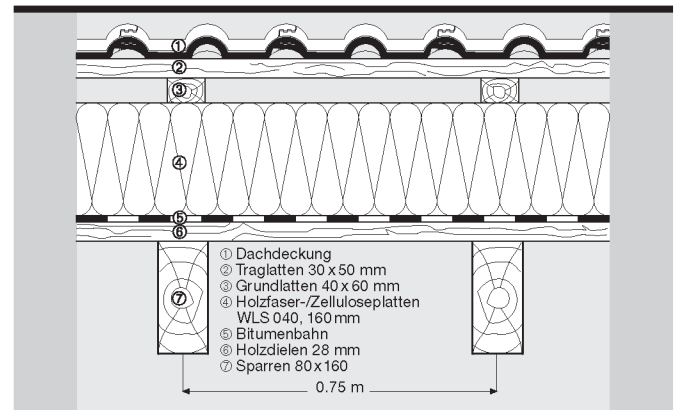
Steildachkonstruktion mit 160 mm Holzfaserplatte (WLS 040), als Dämmung auf den Sparren, Profilholzschalung mit Luftdichtheitsschicht, sichtbare Sparren.
